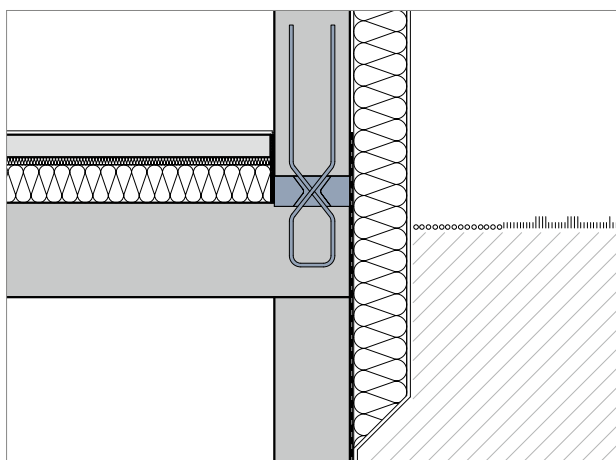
Schöck Sconnex® typ M ve vnitřní stěně u podstropní tepelné izolace
